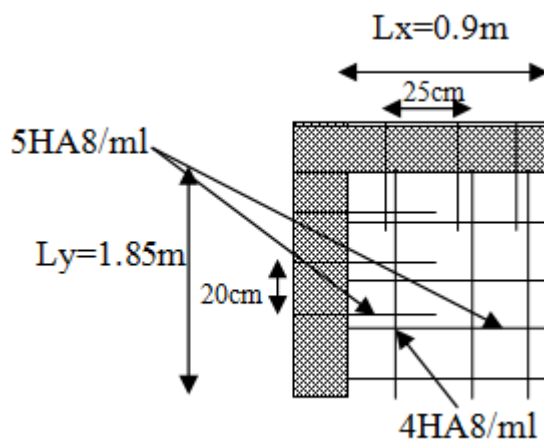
schéma de ferrailage de la dalle sur 2 appuis.
